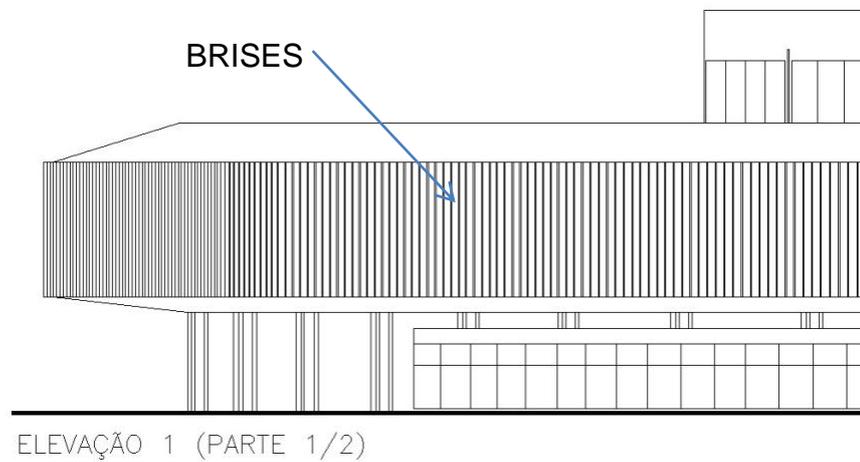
Desenho de parte da fachada com brises verticais do pátio de estacionamento.
